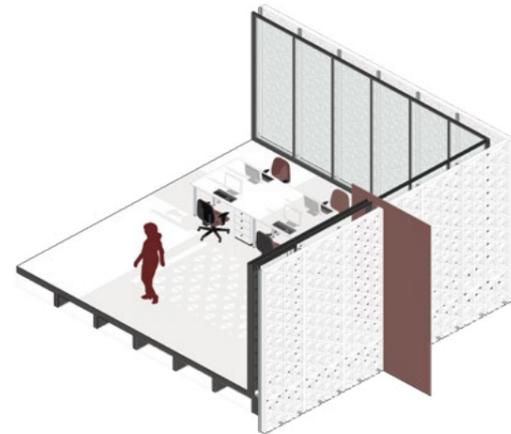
Sección constructiva - Anclaje de GRC (Img 11). Fuente: Autoría propia.
